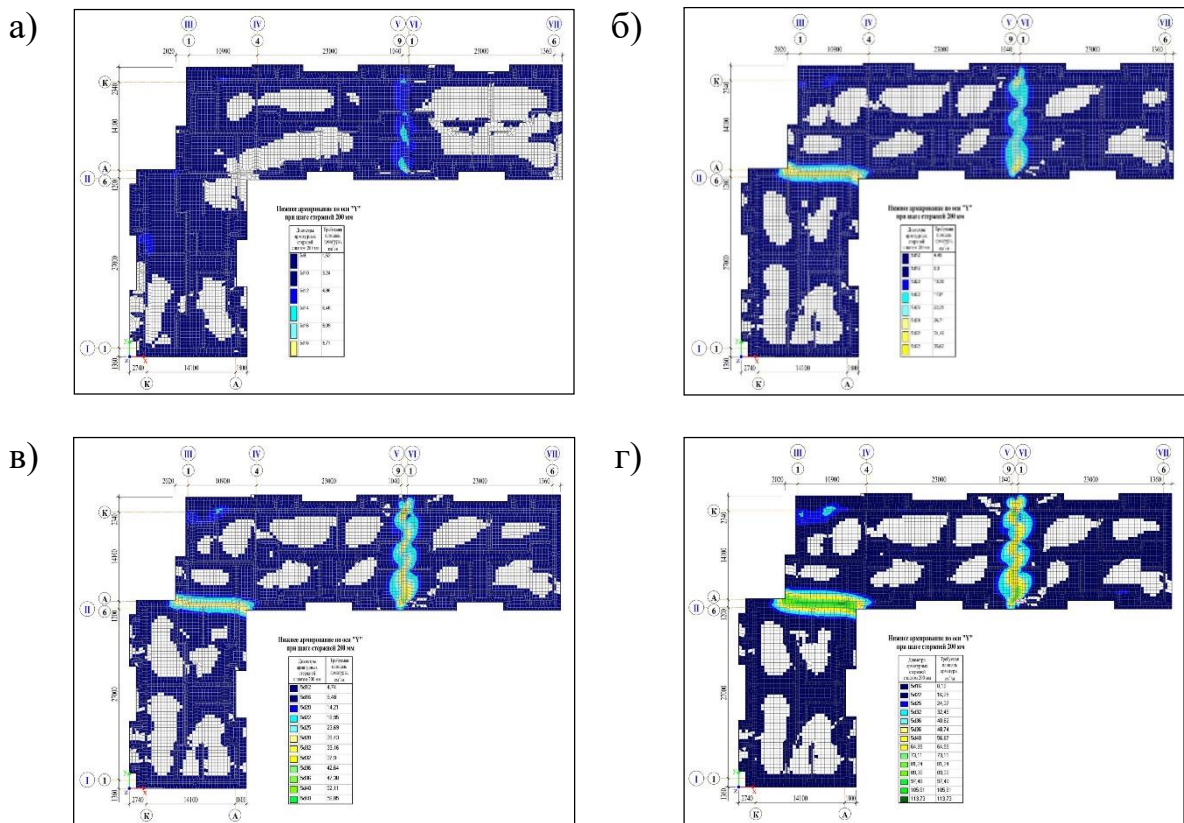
Карты нижнего армирования фундаментной плиты (вдоль оси «Y») на разных стадиях строительства: а) фундаментно-подвальная часть; б) 3-этажное здание; в) 5-этажное здание; г) 7-этажное здание
